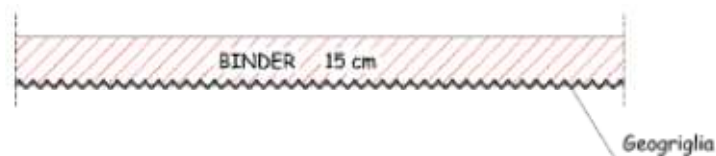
Proposta di variante, sezione tipo risanamento profondo
